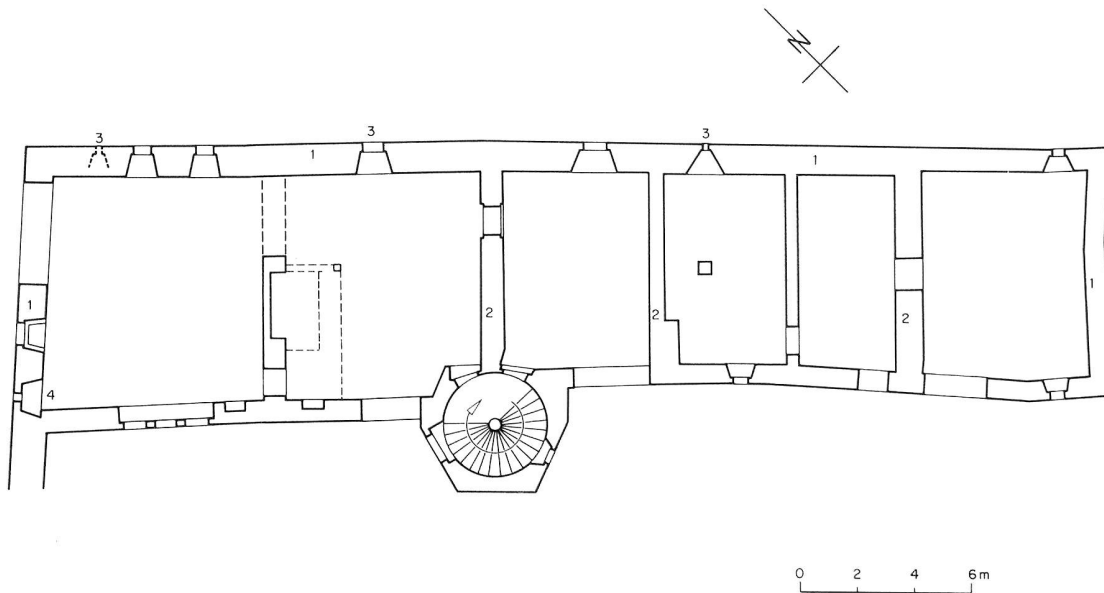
Vuissens/Château. Plan du rez-de-chaussée de l'aile nord. 1) enceinte, 2) murs de refend médiévaux, 3) meurtrières, 4) canonnière (1:250)
